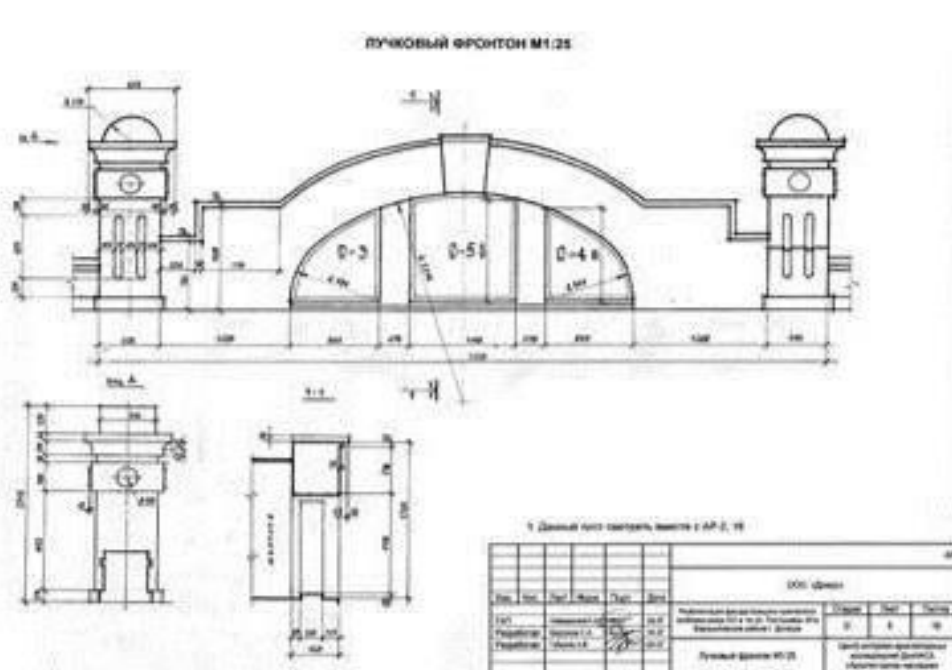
Обмеры деталей: подробный обмер лукочного фронтона
